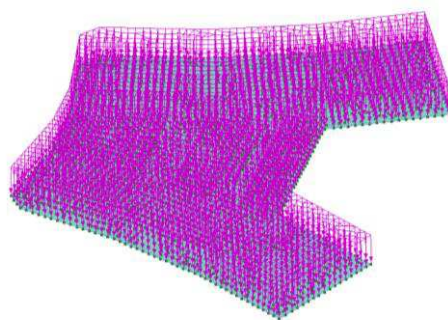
Нагрузка от кровли верхнего этажа
